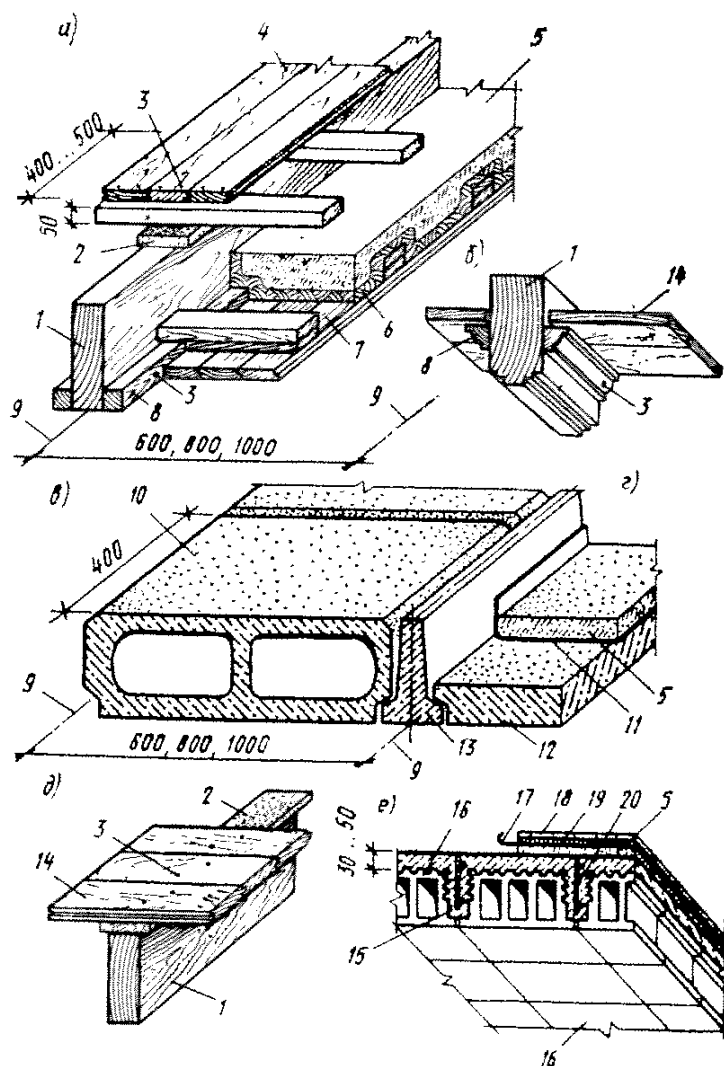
Схемы конструктивных решений перекрытий:
